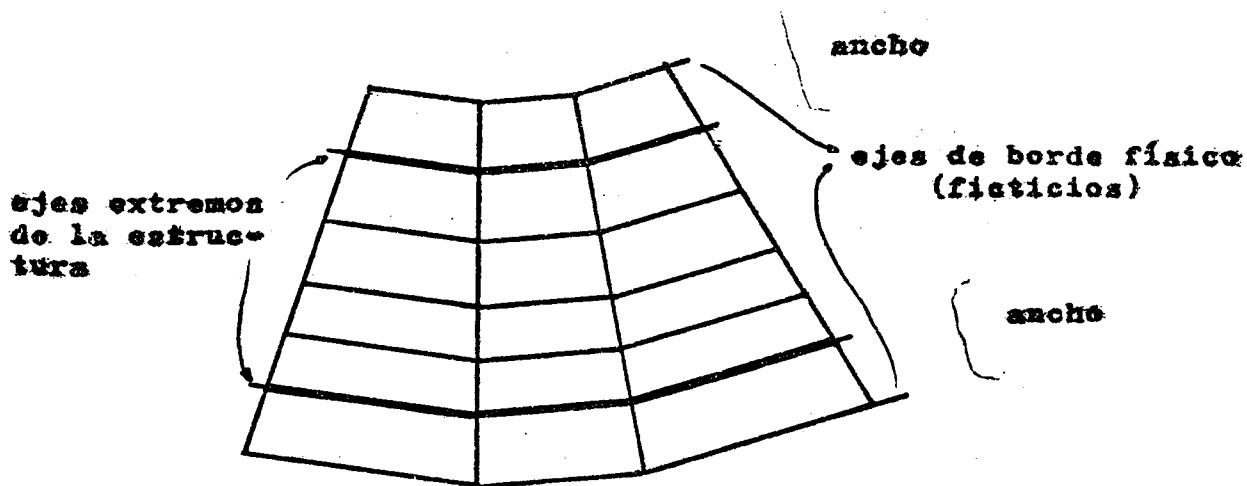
CONSTRUCCION DE VOLADIZOS DE CALCULO
